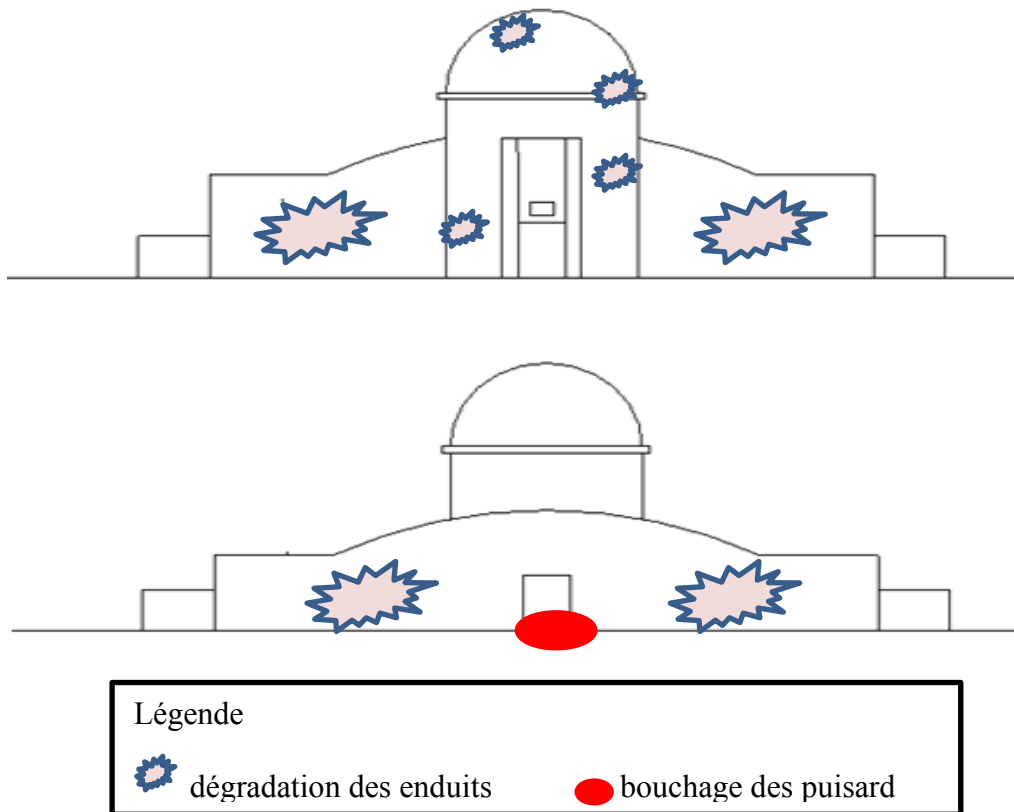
'etat de lieux de djoub boutrikfin dans façades fait par l'auteur
